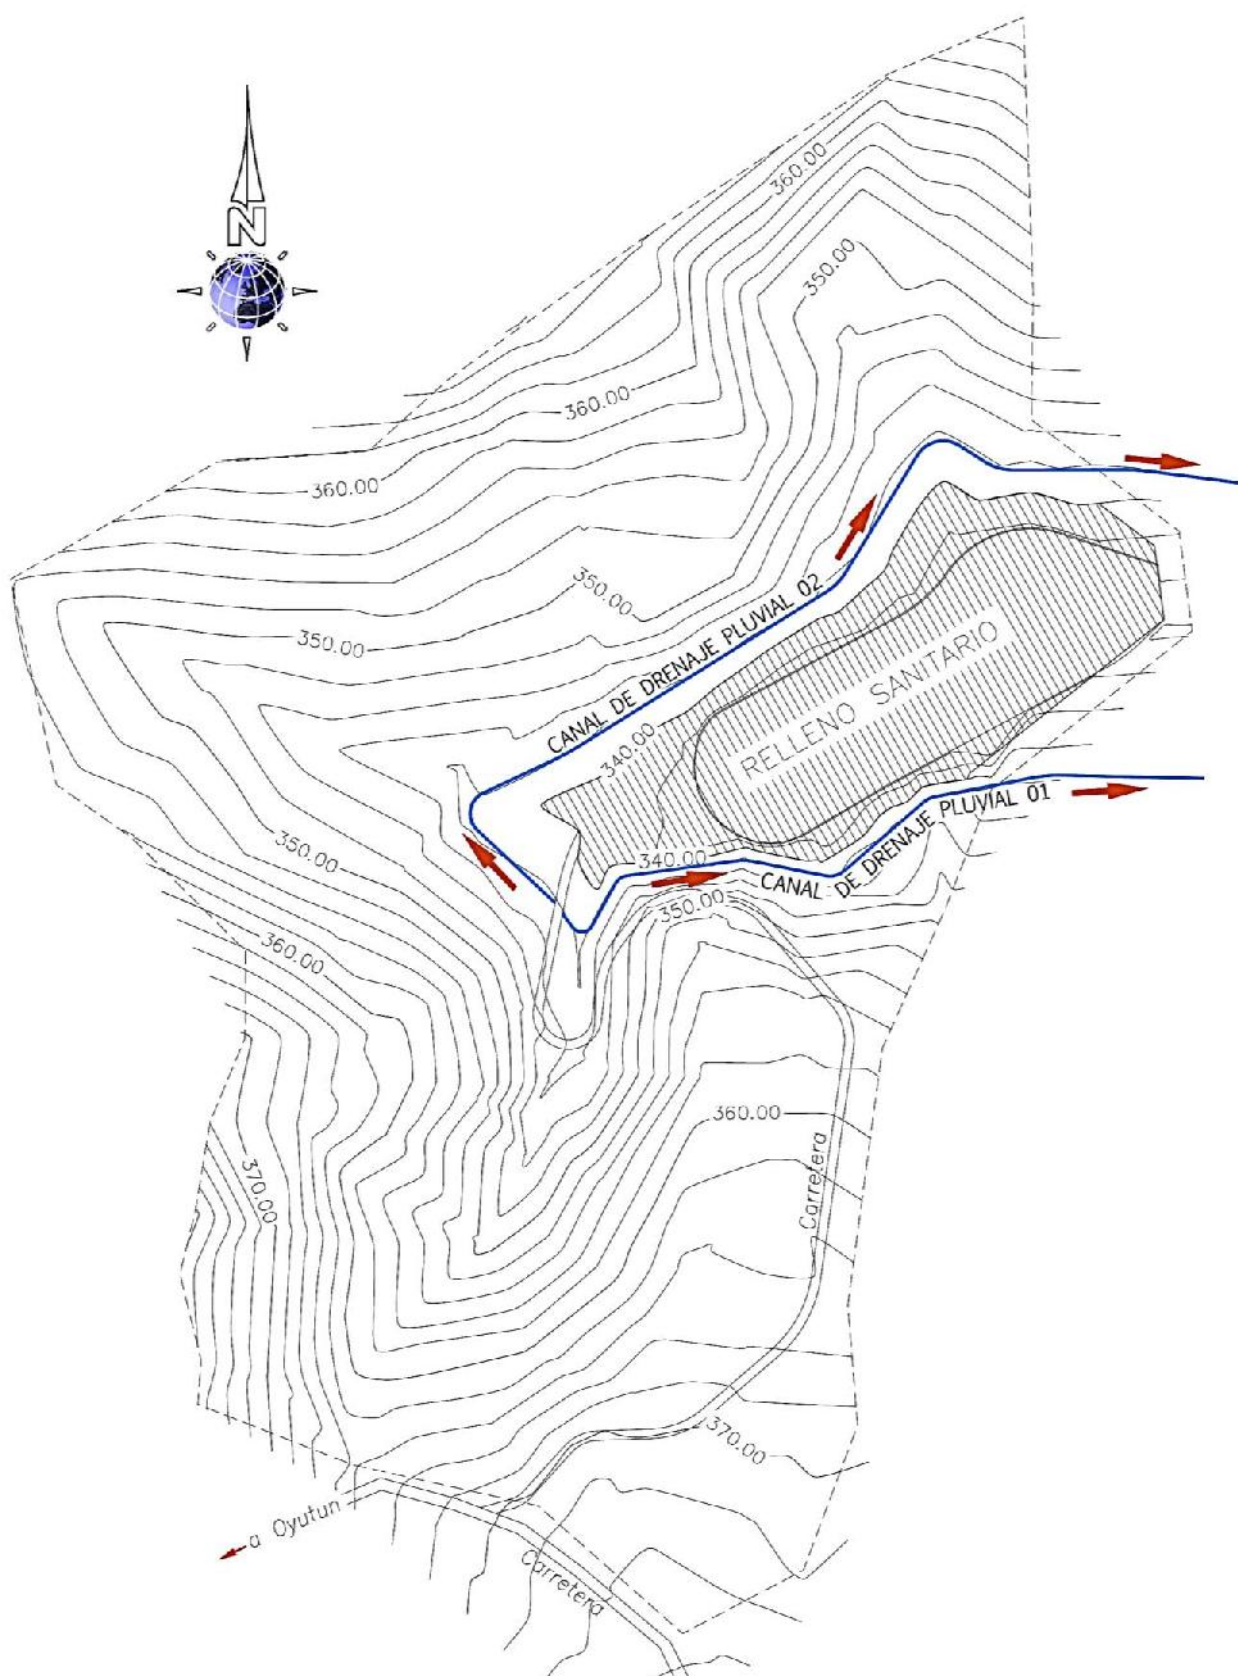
Distribución de Canales Perimetrales Para el Drenaje Pluvial
